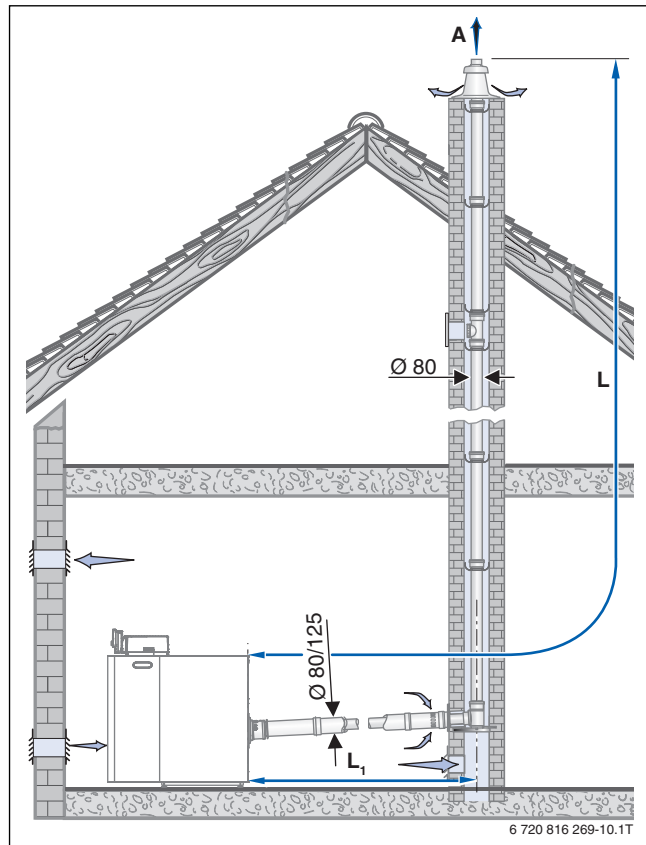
Guía de tubo doble a la chimenea, conducción por tubo individual en la chimenea (B₃₃, rígido)
